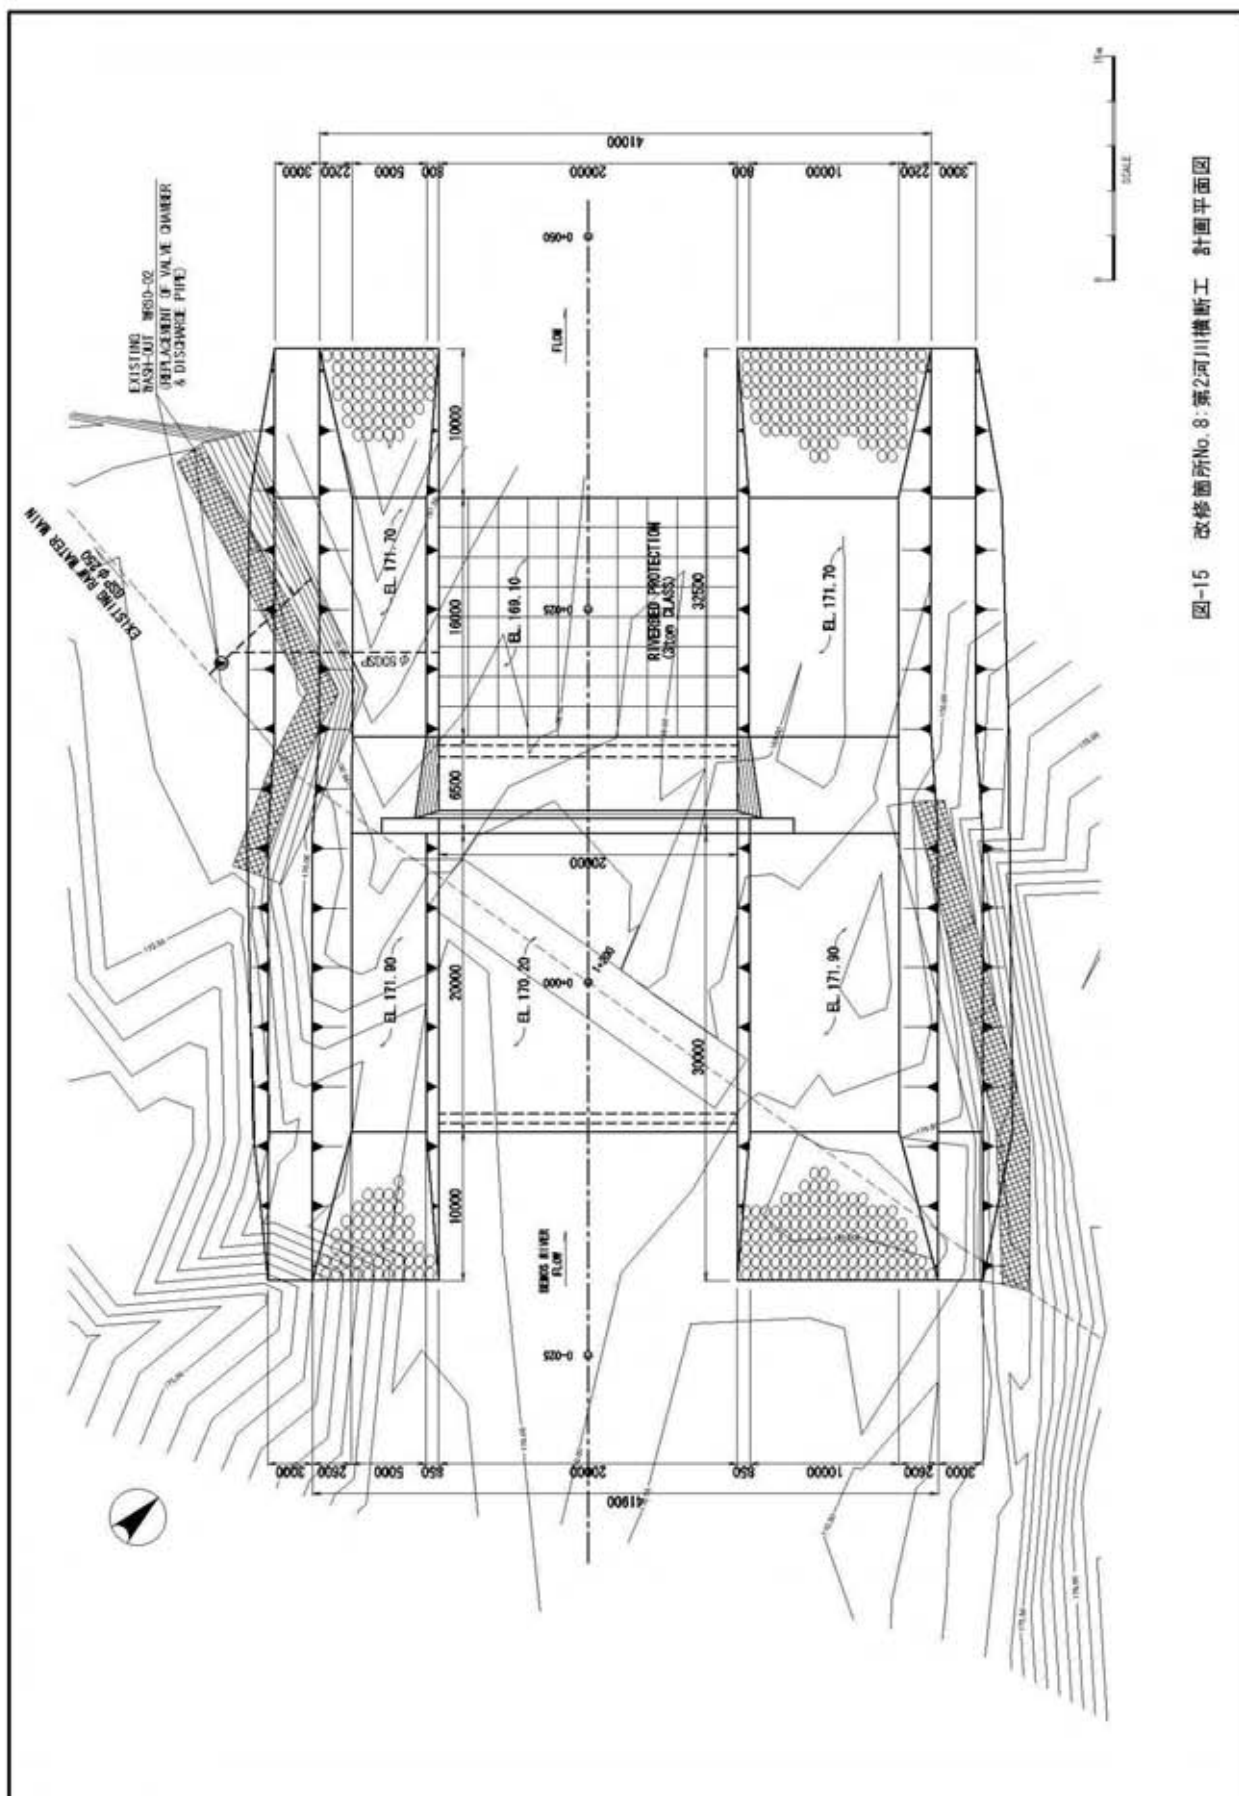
改修箇所No.8:第2河川横斷工 計画平面図
